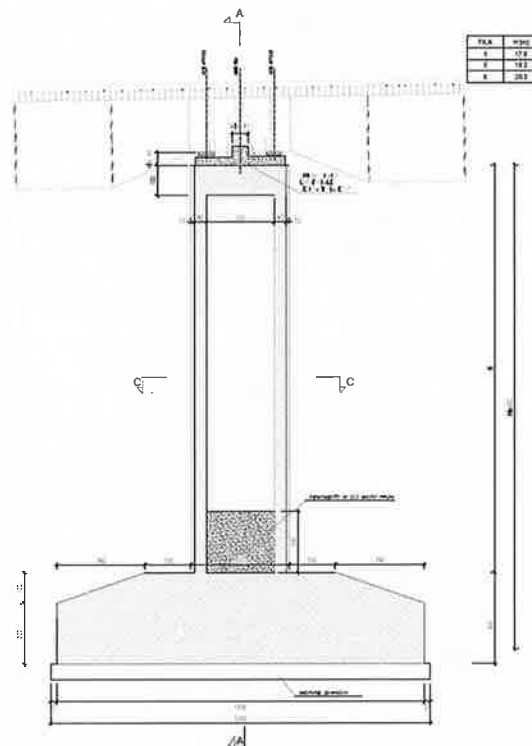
Sezione longitudinale pila H > 15m, Bonorva VI01
